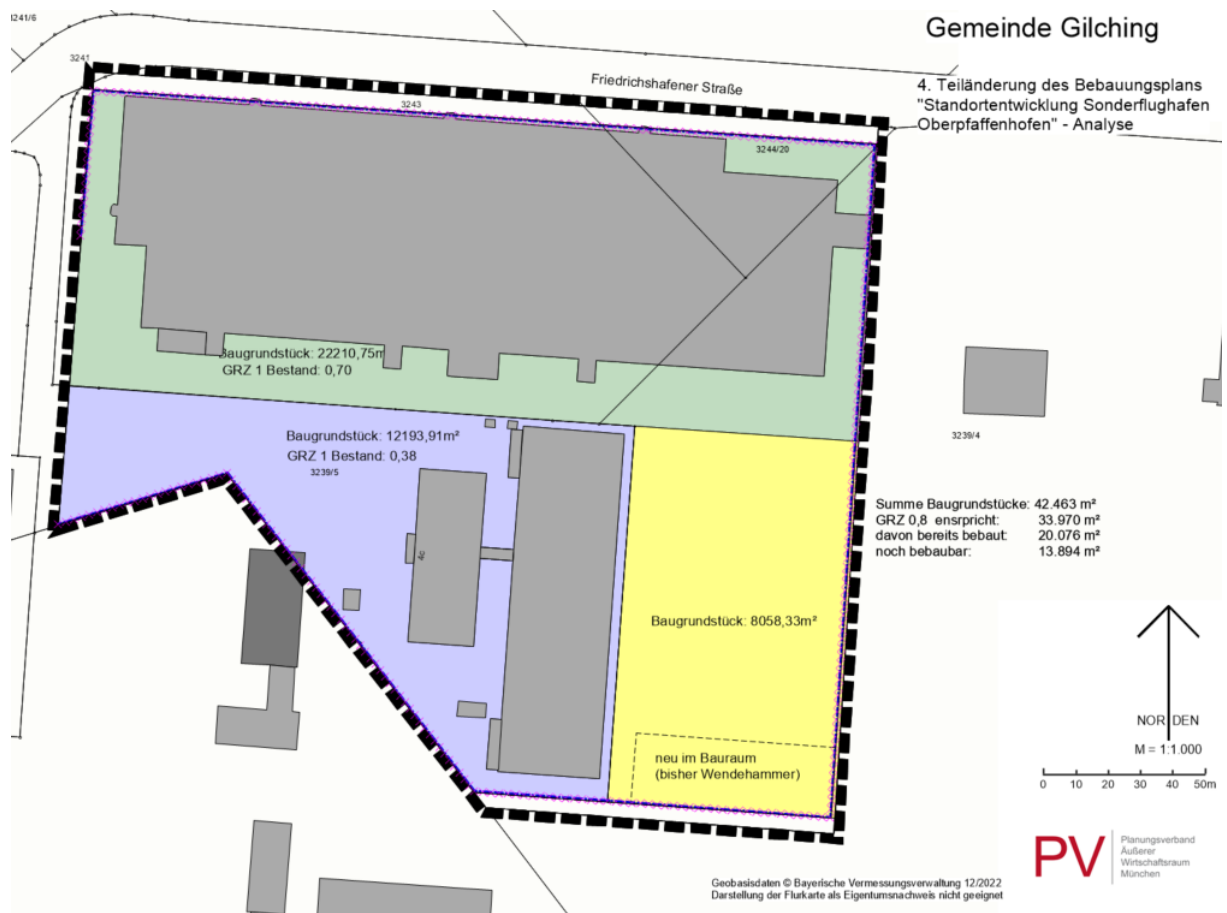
Flächenbilanz auf Basis angenommener Baugrundstücke
